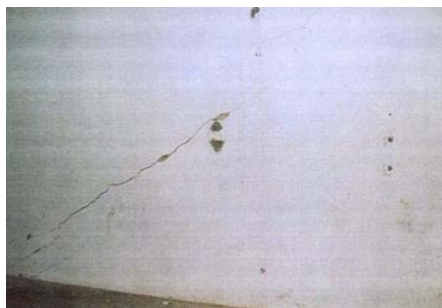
Fissuras provocadas por assentamentos diferenciais das fundações. Fonte: Branco & Brito (2015a)
